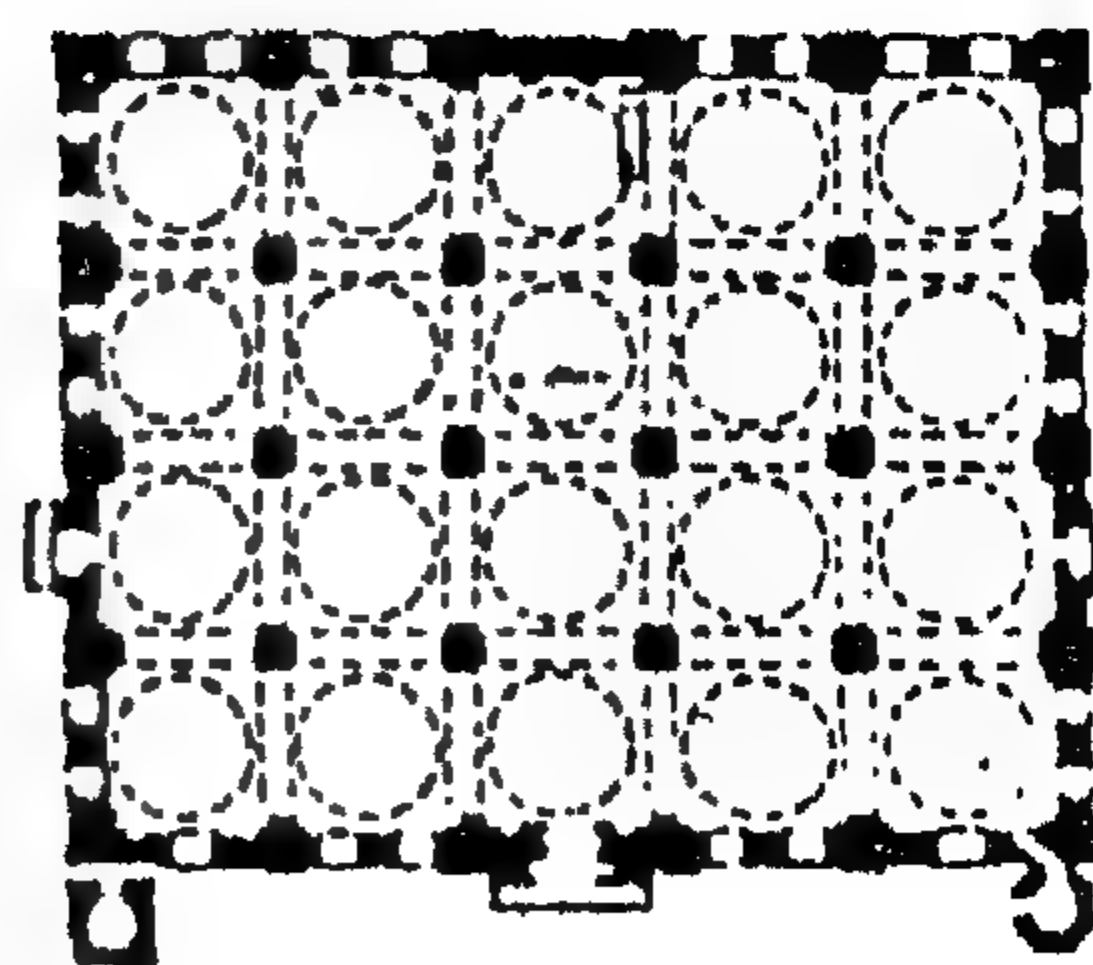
مسقط أفقي لمسجد ترمذ . (عن : Hillenbrand) .
